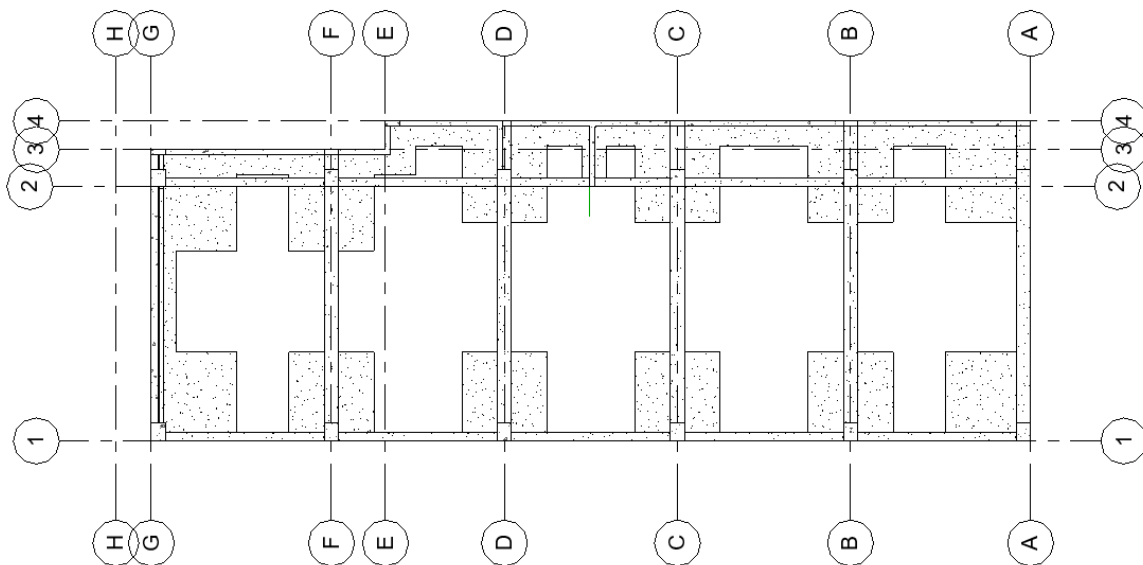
Vista de distribución de placas, columnas y cimentaciones desde Nivel 1 (Fuente: Elaboración Propia).
